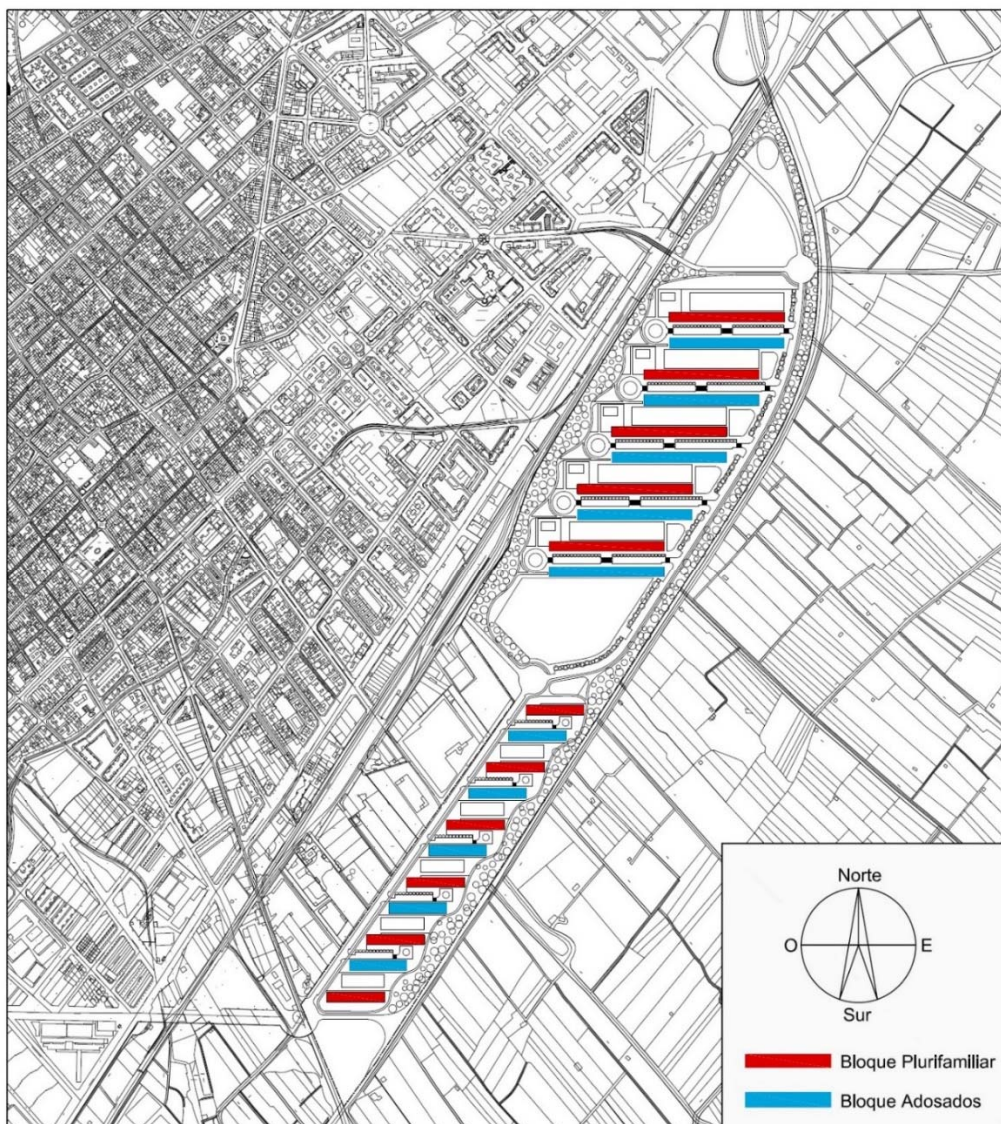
Estructura de la Propuesta Urbanística. Disposición de los bloques
